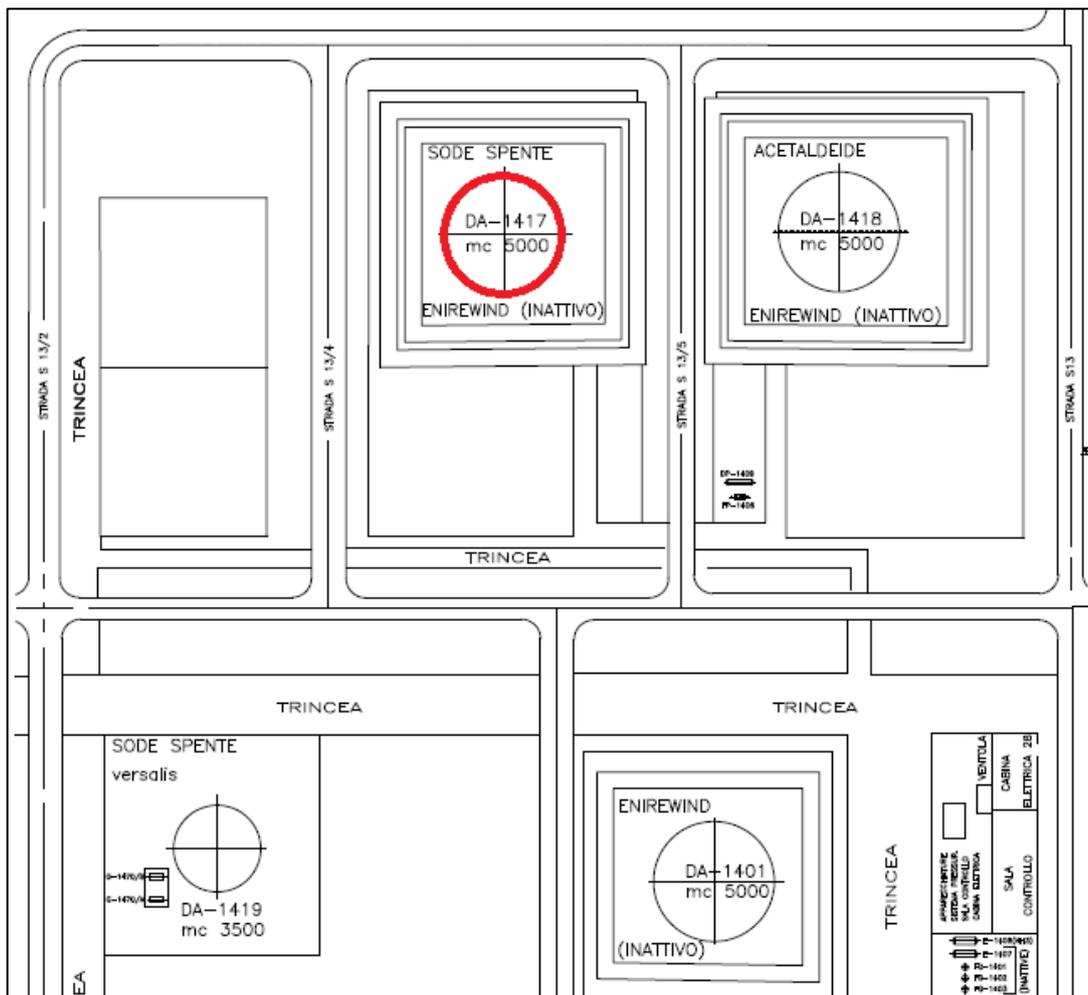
Dettaglio posizionamento planimetrico serbatoio acque sode DA1417 in SG14
